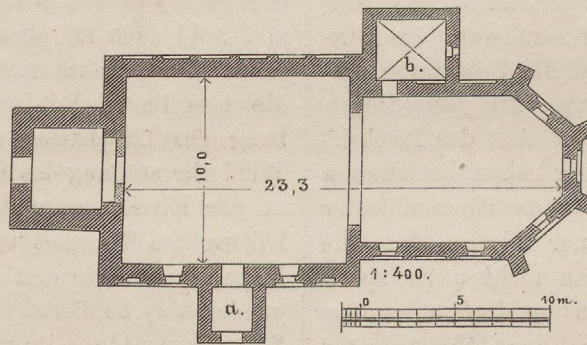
Pienonskowo. Grundriss der Kirche.
